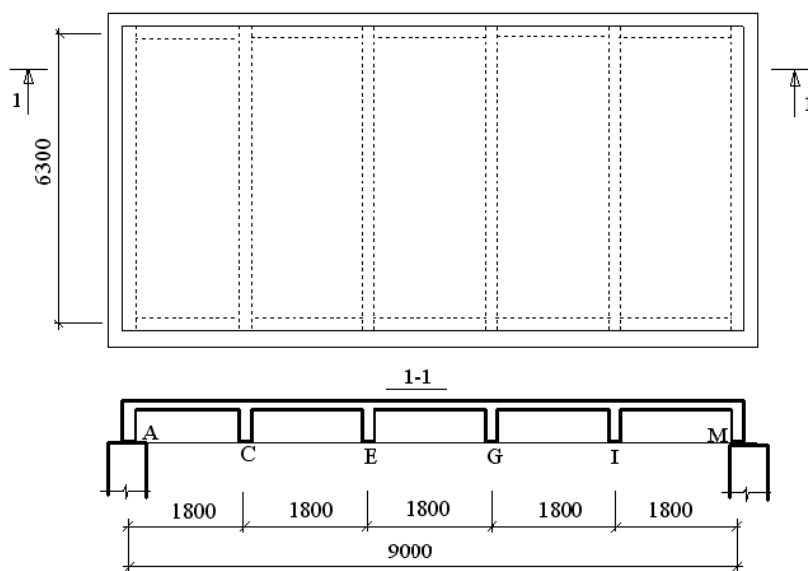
Фрагмент монолитного ребристого перекрытия к примеру расчета
